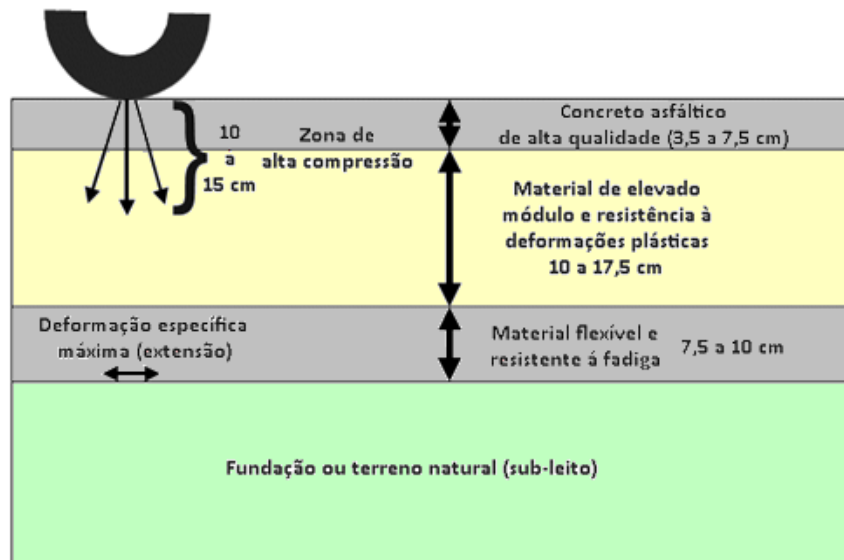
Concepção típica de um pavimento asfáltico “perpétuo”
